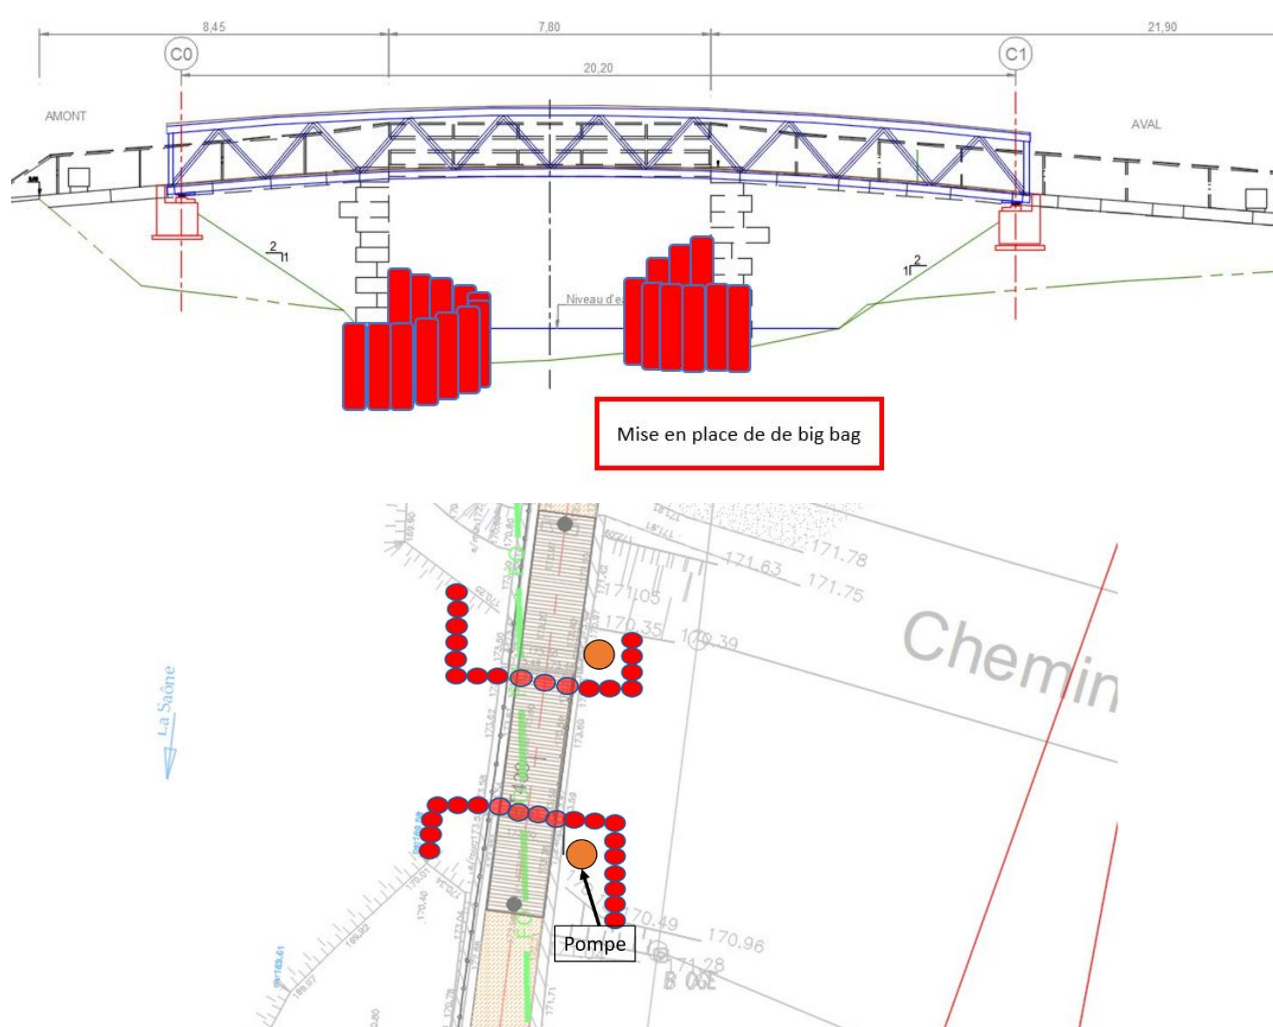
Mise en place de bigbag sur la passerelle d'Arciat
